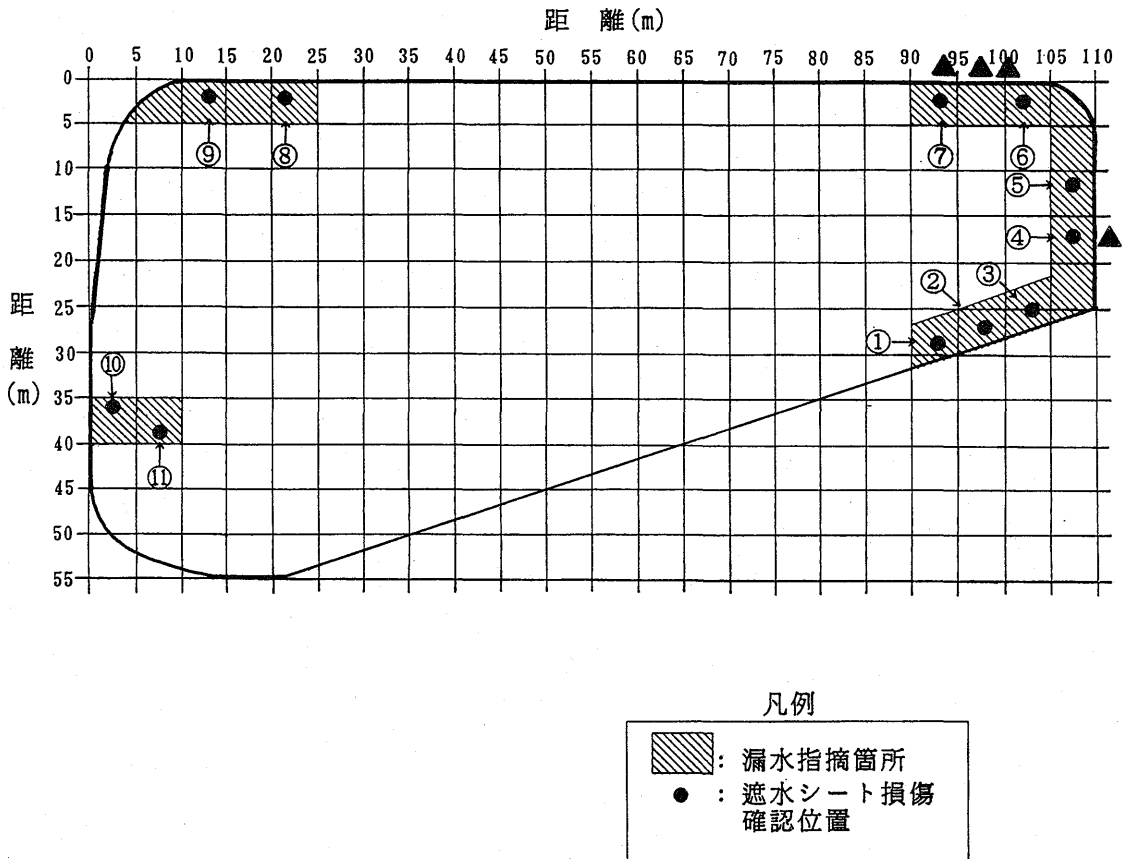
漏水指摘箇所および遮水シート損傷箇所平面図
